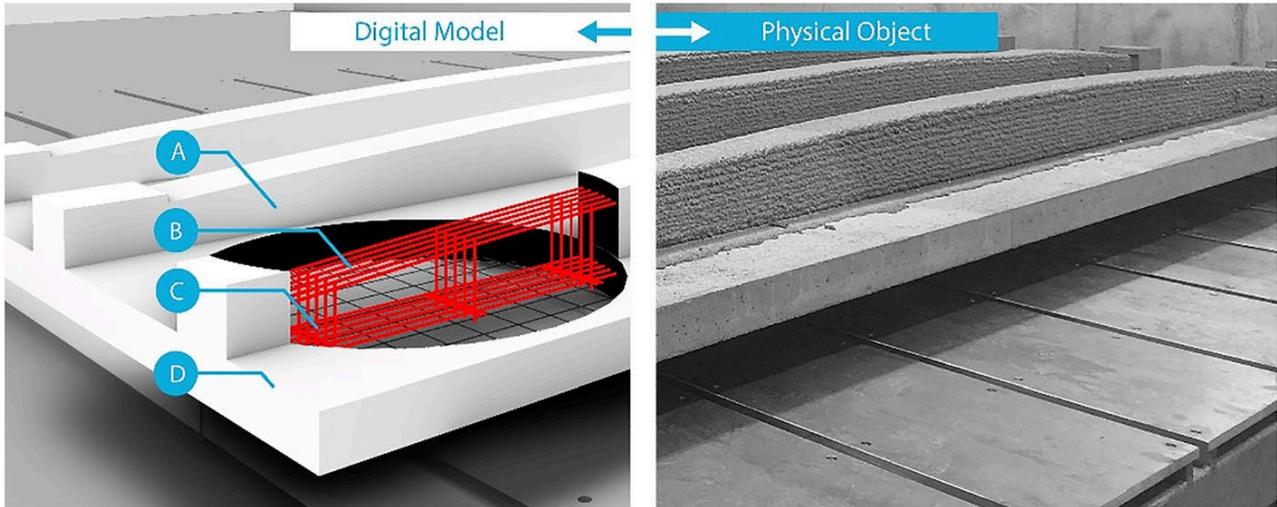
Kombiniertes Fertigungsverfahren einer Betonfertigdecke mit dem SC3DP Verfahren
